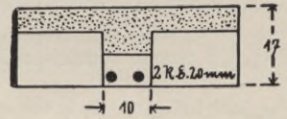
, Balken C_4 (auch C_4 , jedoch mit 2 Einzellasten).
